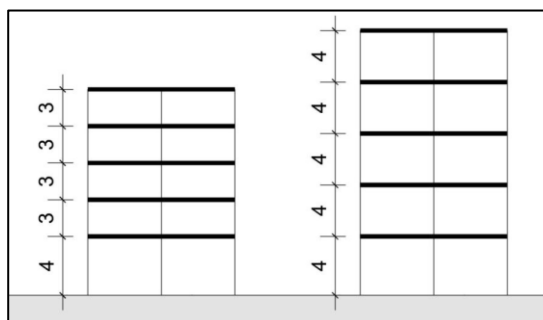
El edificio irregular, ilustrado en el lado izquierdo, genera un punto débil en la planta baja.
